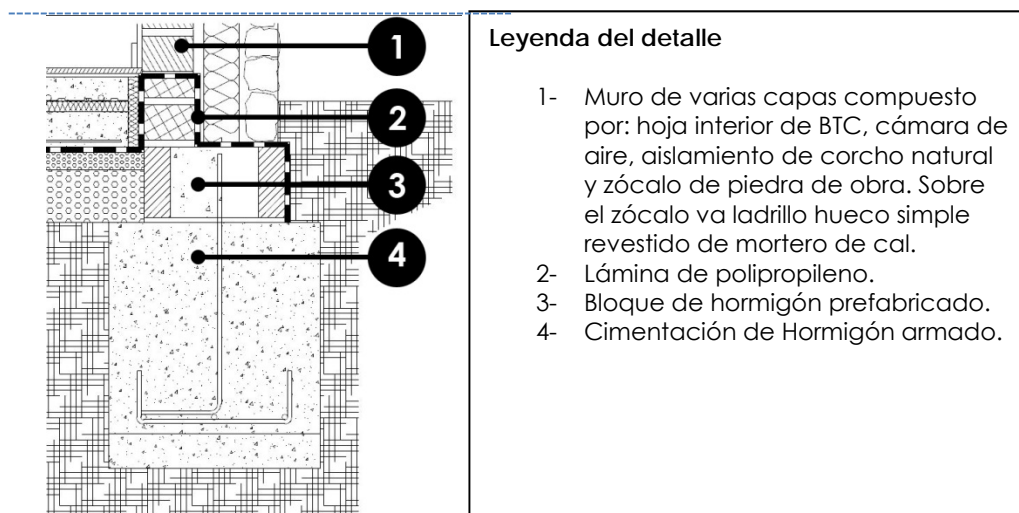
Base del muro. BAR-002. Fuente: Gabriel Barbetá y David Pradas Ruiz. Elaboración propia.
